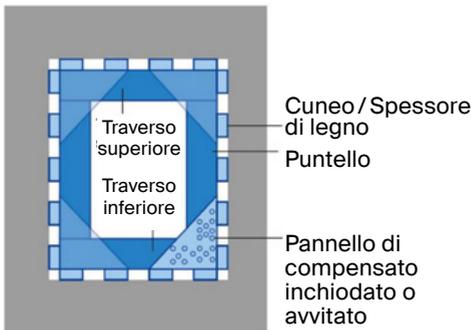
Montaggio di un telaio prefabbricato in legno (Blockhaus, Technisches Hilfswerk – THW)
